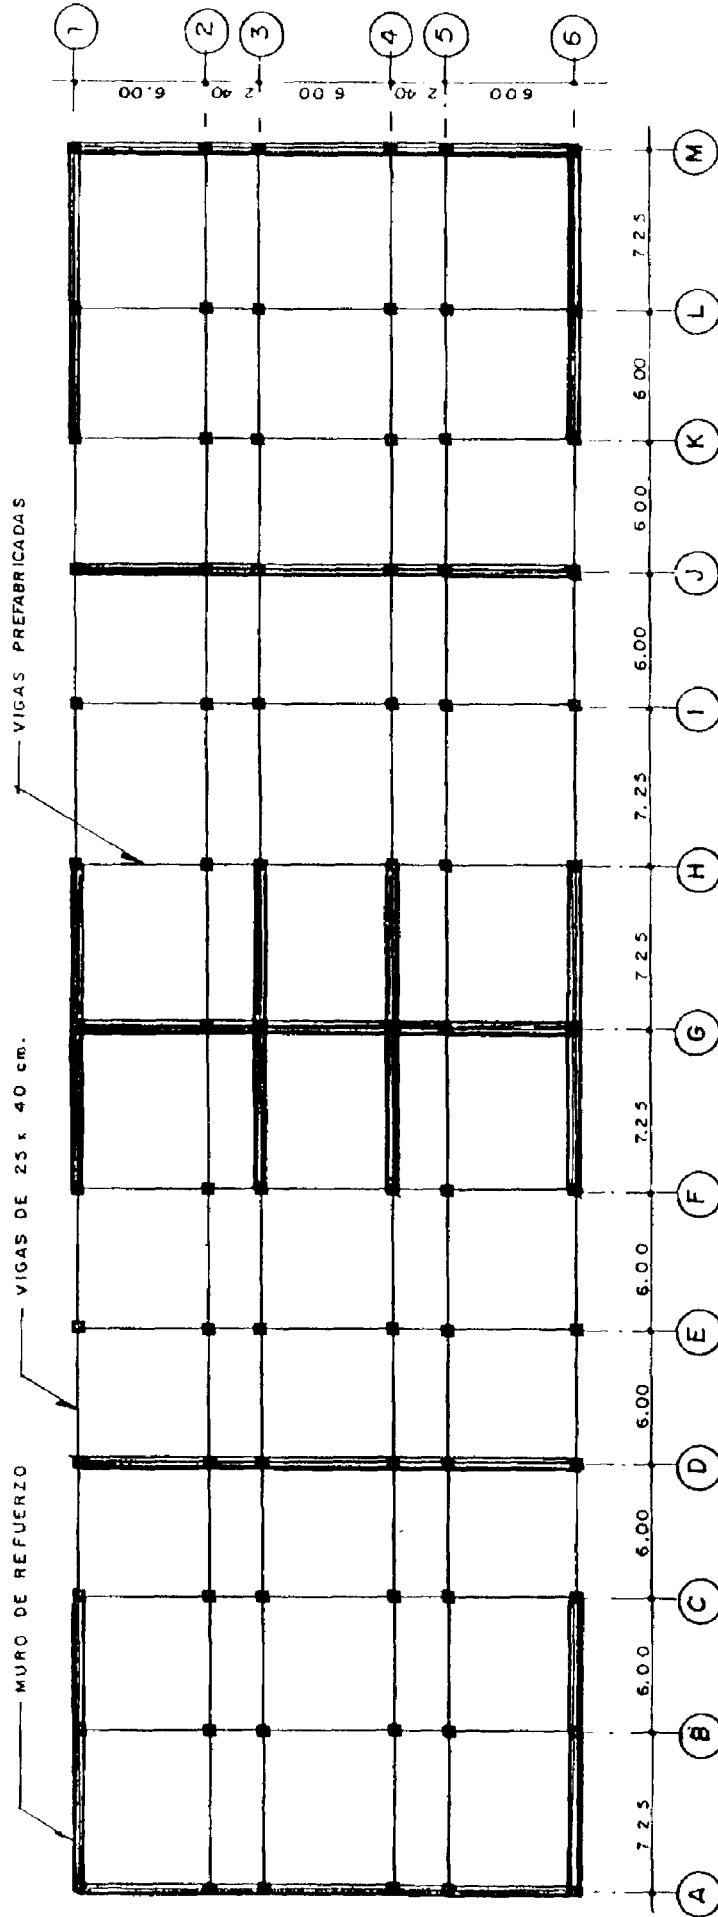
UBICACION DE MUROS DE MAMPOSTERIA REFORZADA EN EL NIVEL SUBPLANTA BAJA
